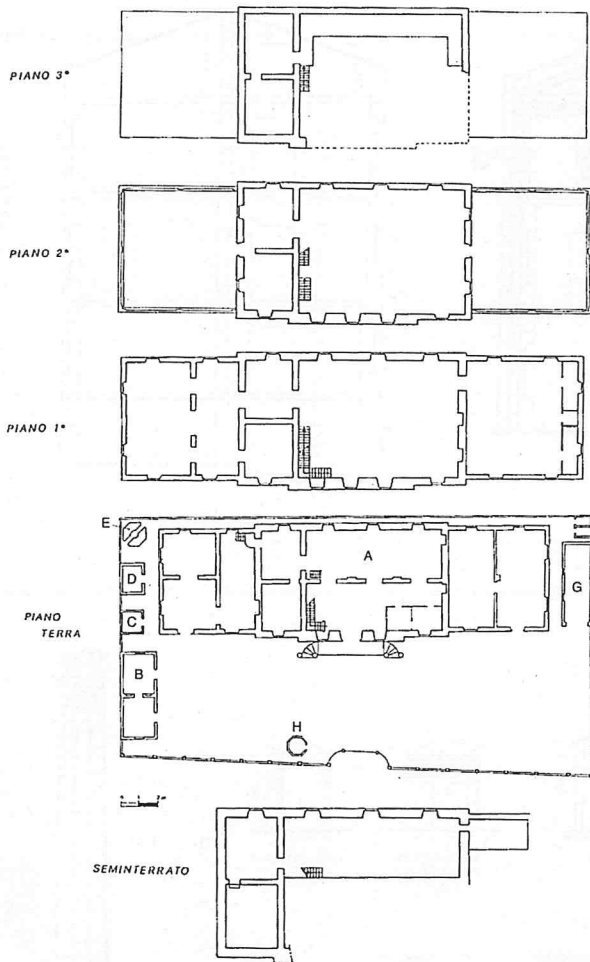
Pianta dell'antico molino «Pagano» oggetto di studio.
